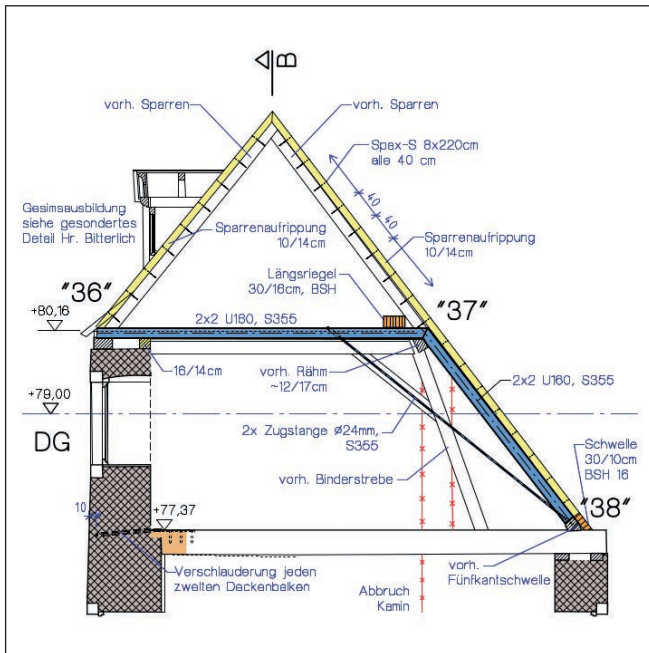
Verstärkung des einhäufigen Daches – Maßnahmenplan.
